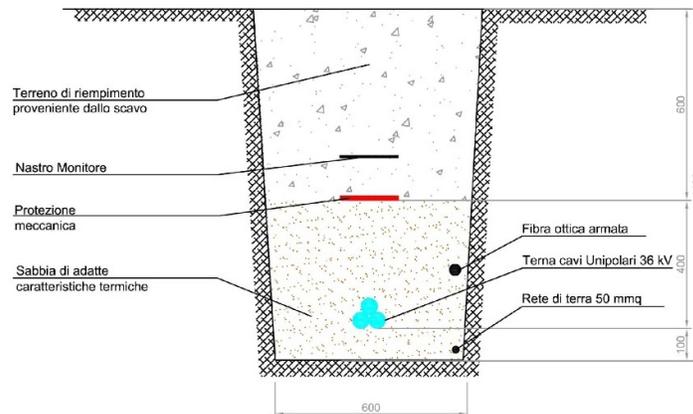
Sezione tipo di scavo su terreno agricolo
